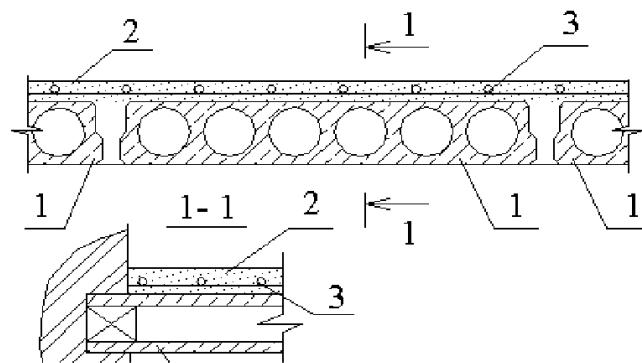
Нарощування пустотних плит перекриття: 1 - плита, що підсилюється; 2 - монолітний шар бетону; 3 - арматурна сітка
